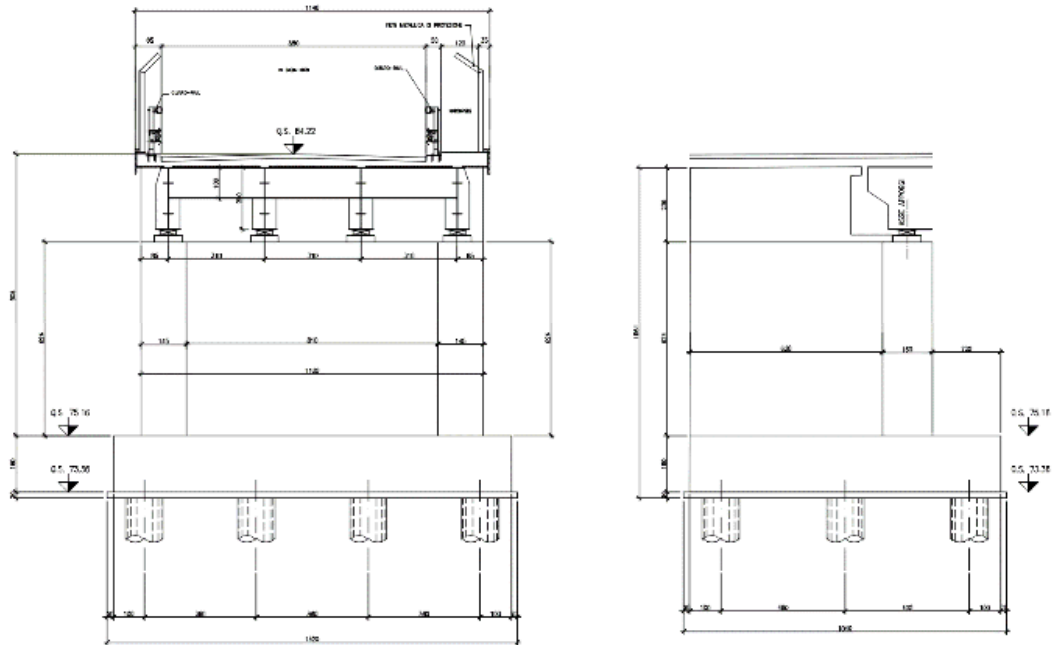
IV02 Cavalcavia Tangenziale Ovest - Viste spalla S1
